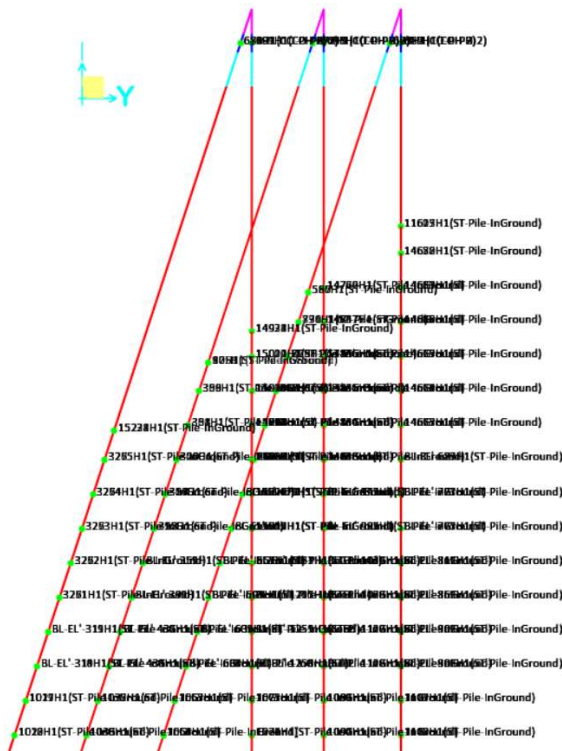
Rótulas plásticas en la parte superior e inferior de los pilotes inclinados de acero
